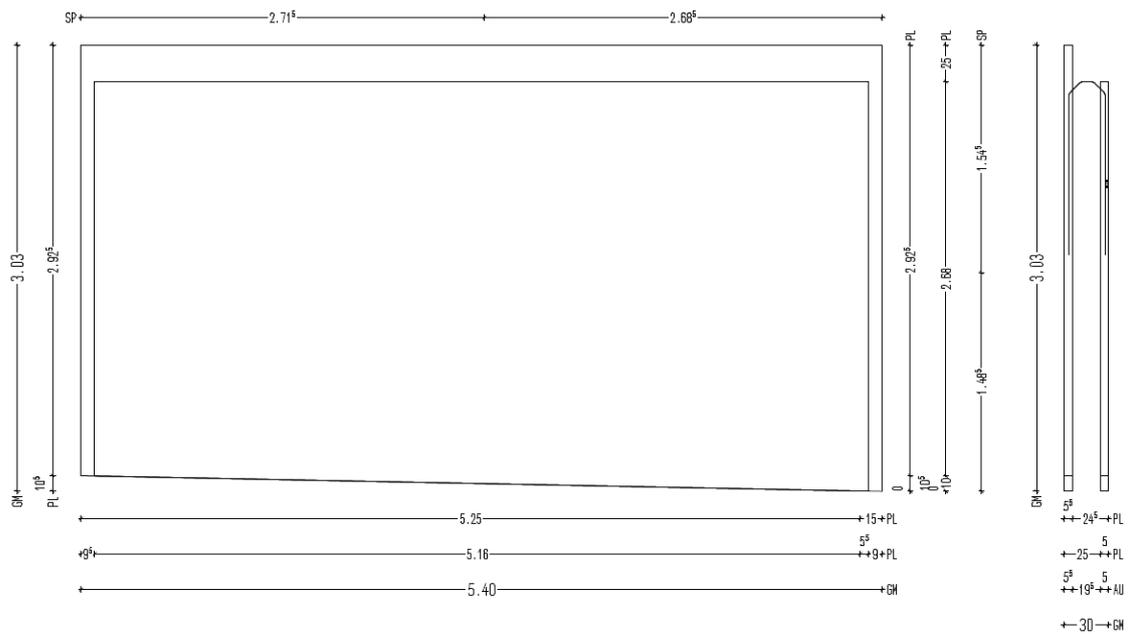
Ausschnitt eines Produktionsplans [OBE16]
